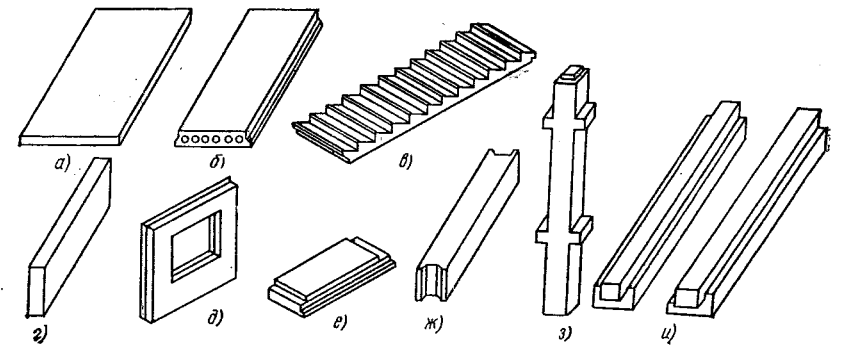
Схемы основных железобетонных изделий для жилищно-гражданского строительства:
